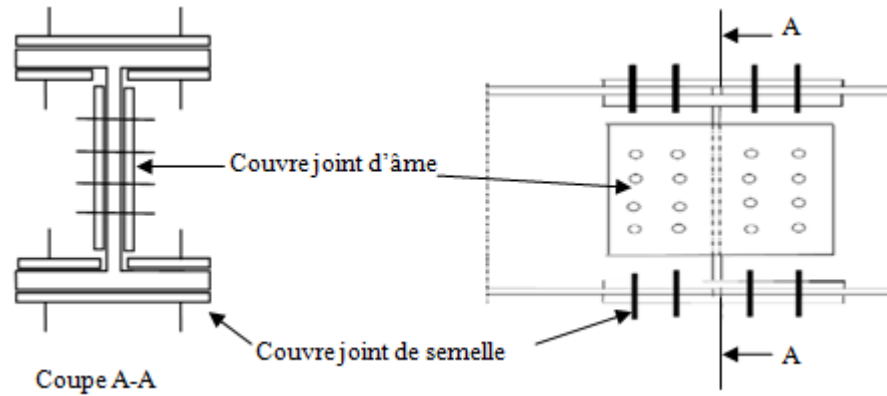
Couvre joint d'âme et semelle d'un profilé en IPE.
